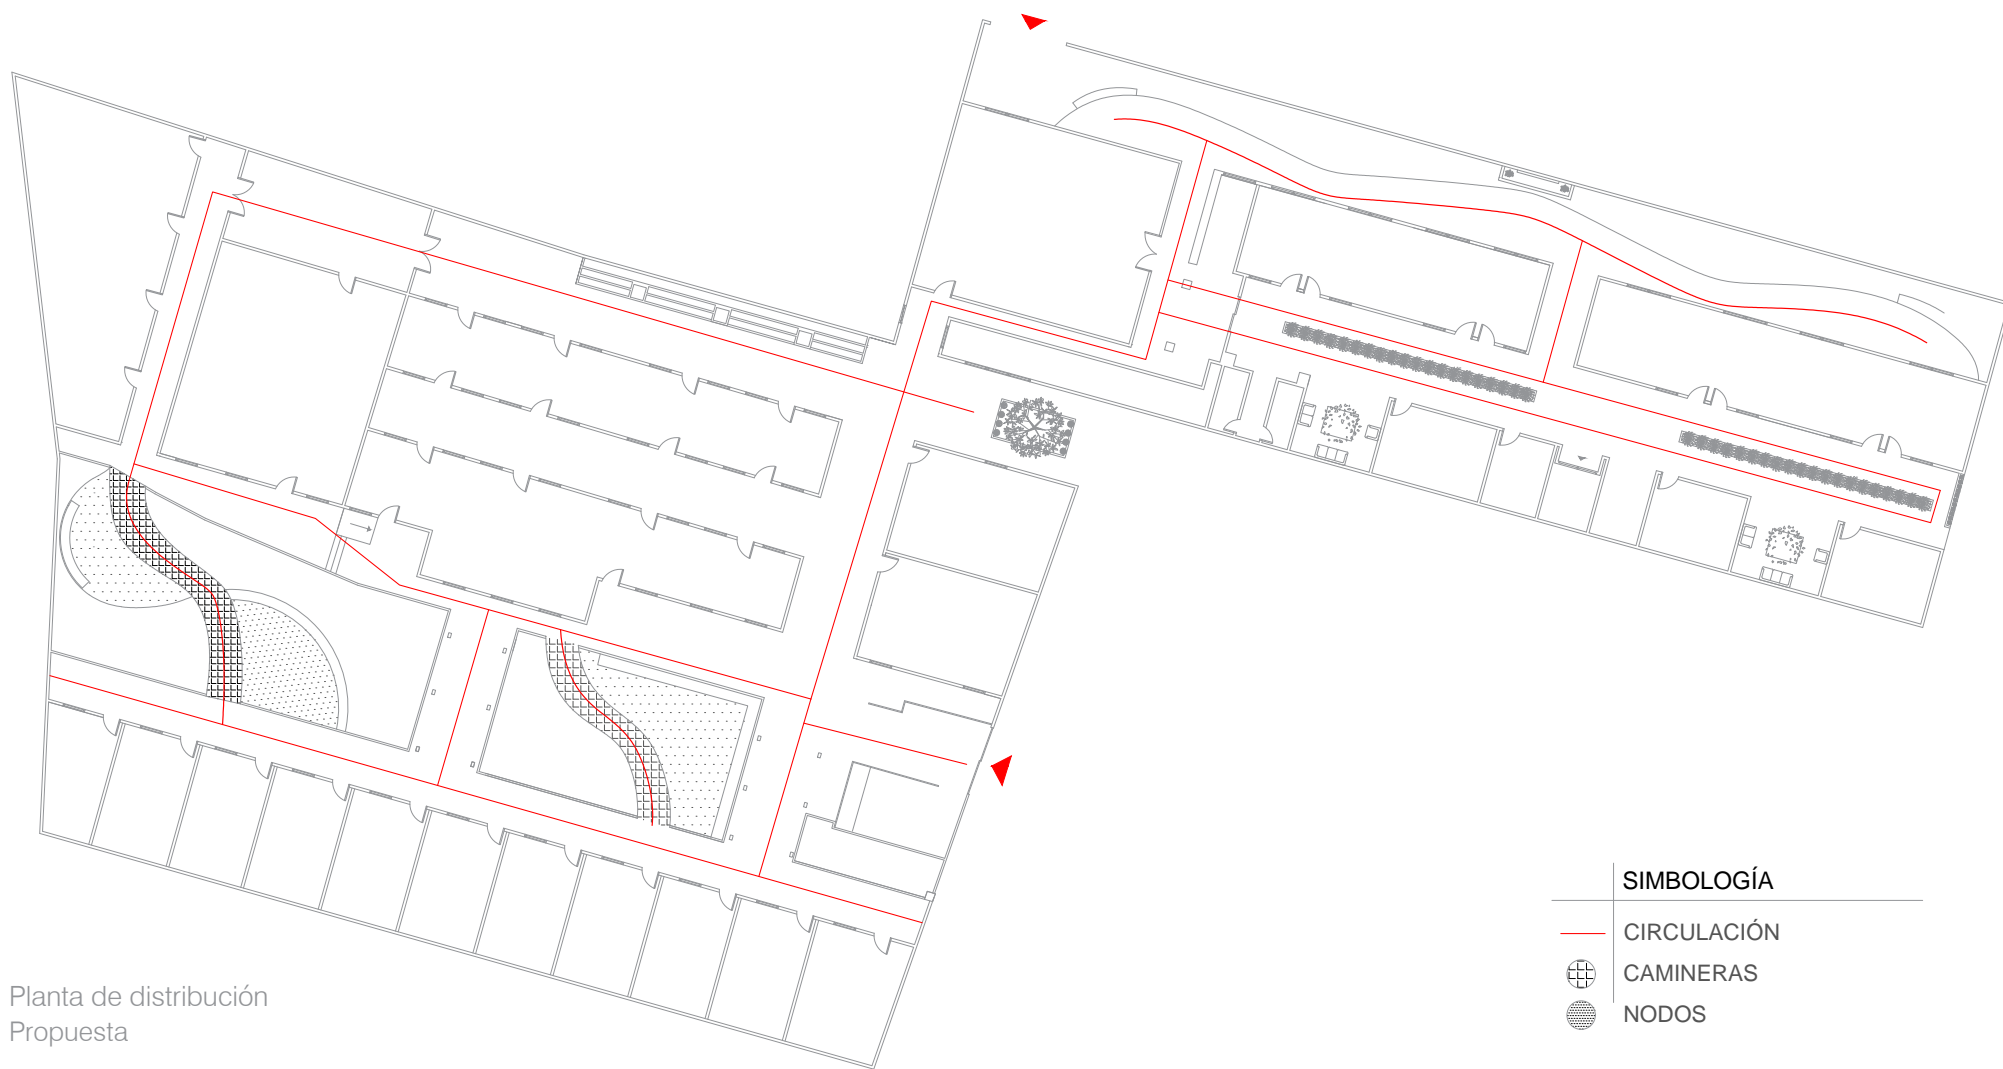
Planta de zonificación. (Redrován, 2024).
